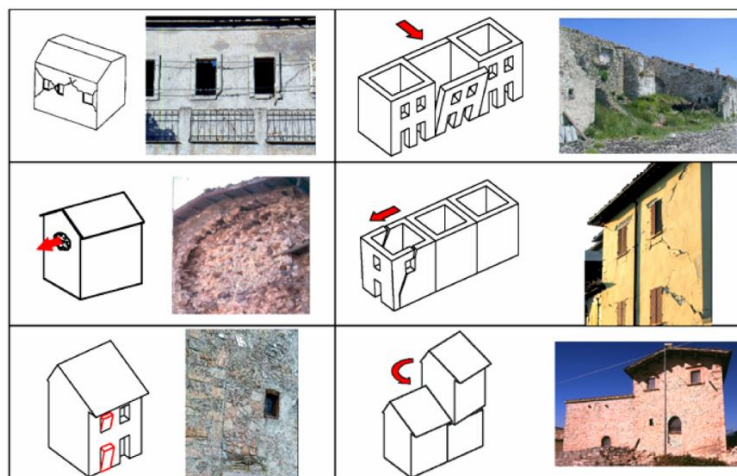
Exemplos de mecanismos de colapso de estruturas de alvenaria [30]
